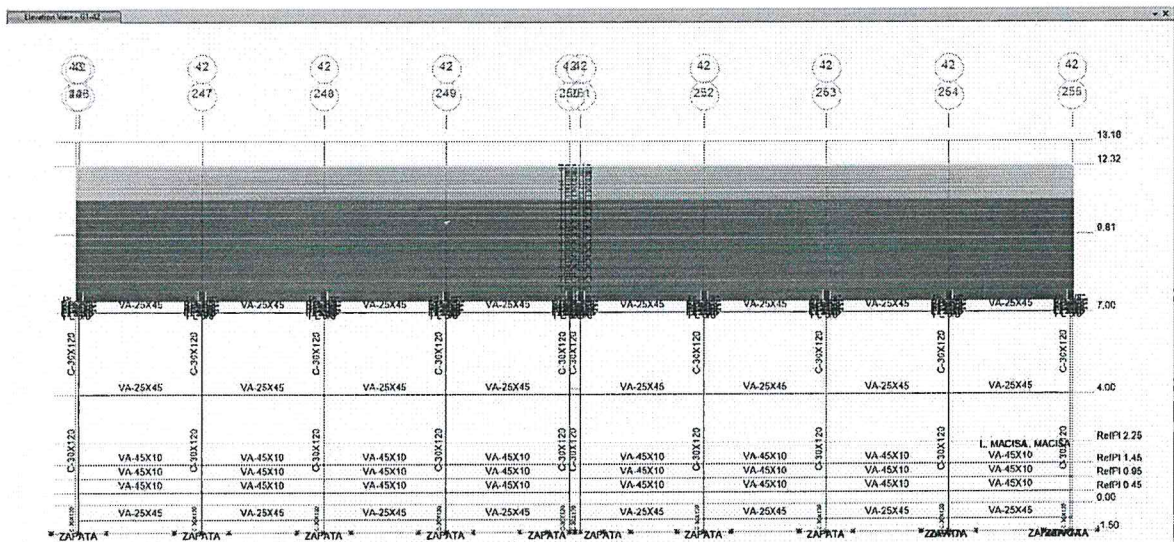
Vista en Elevación del modelo estructural de la Edificación 19-20 sistémico analizado. Los elementos no estructurales fueron ingresados como cargas permanentes
